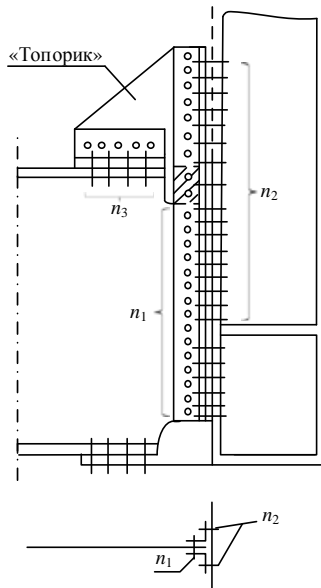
Схема прикрепления поперечной балки к узлу главной фермы
